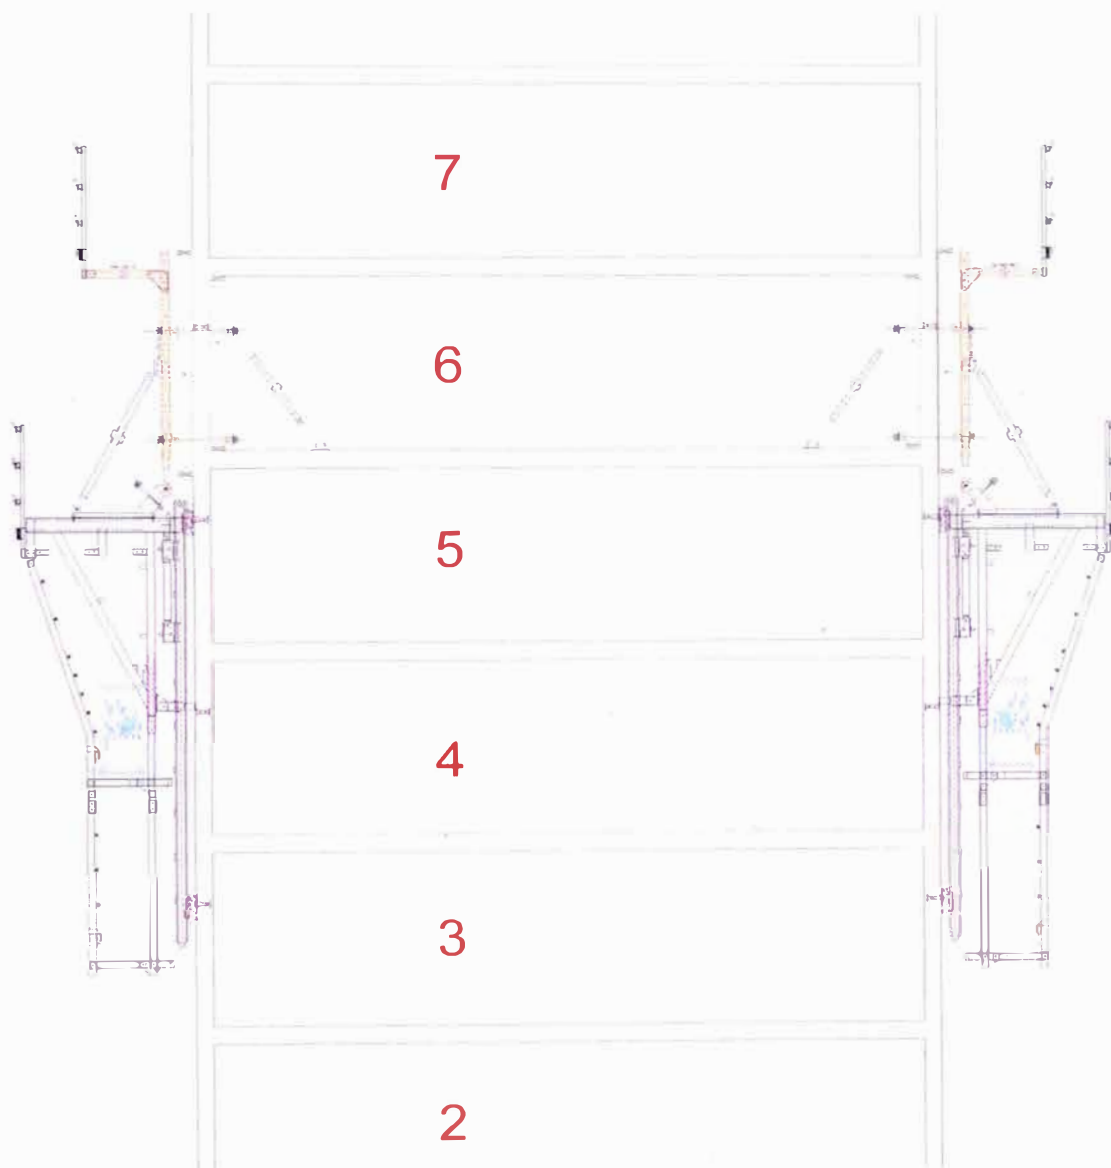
Vista planta encofrado auto trepante en placas exteriores
